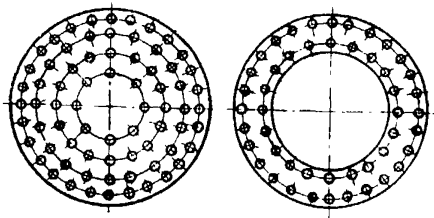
Схемы расположения свай в свайном поле круглых и кольцевых фундаментов.
